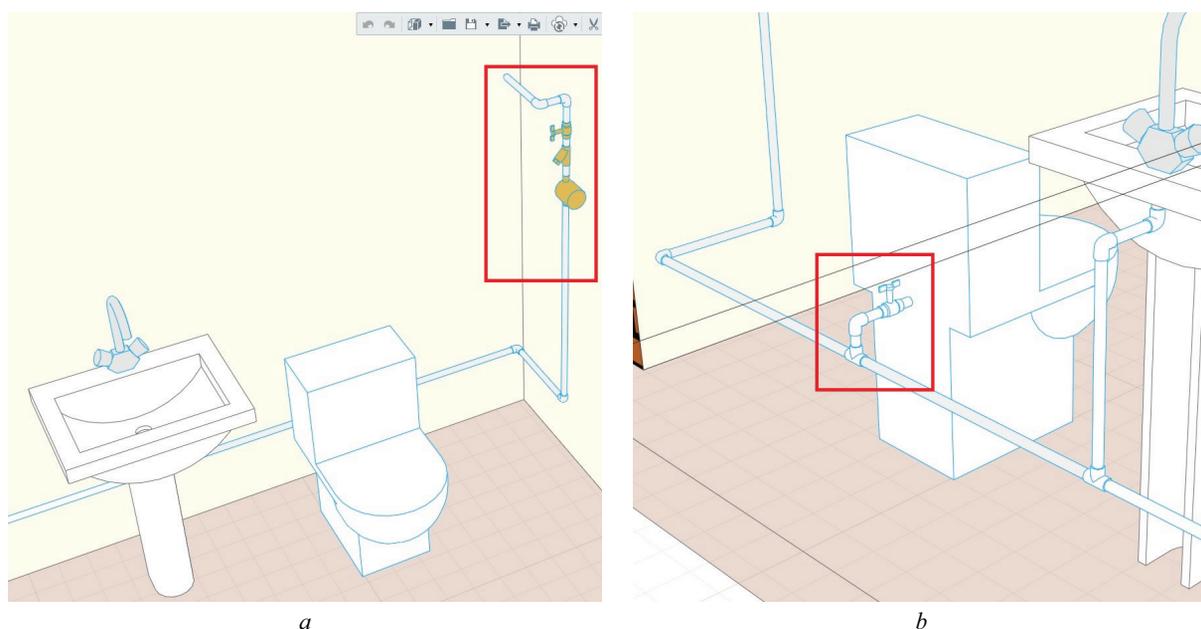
Размещение арматуры и оборудования на квартирной разводке водопровода
